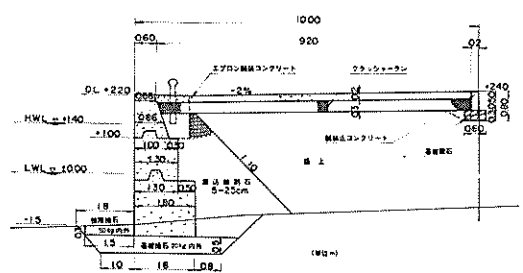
女川港大石原物揚場(-1.5m)標準断面図
